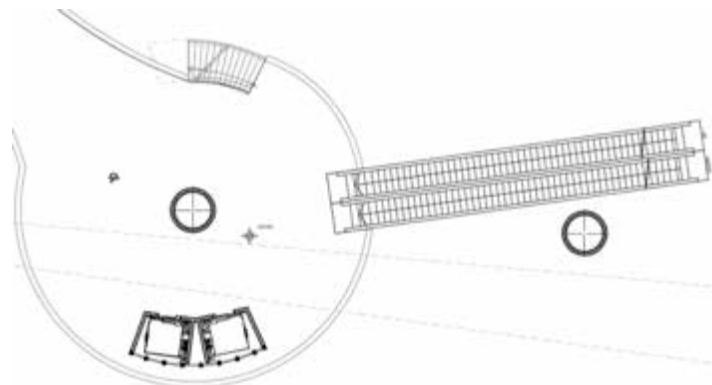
Plaza de acceso 2, planta 2 (+9.45m). (2017)
